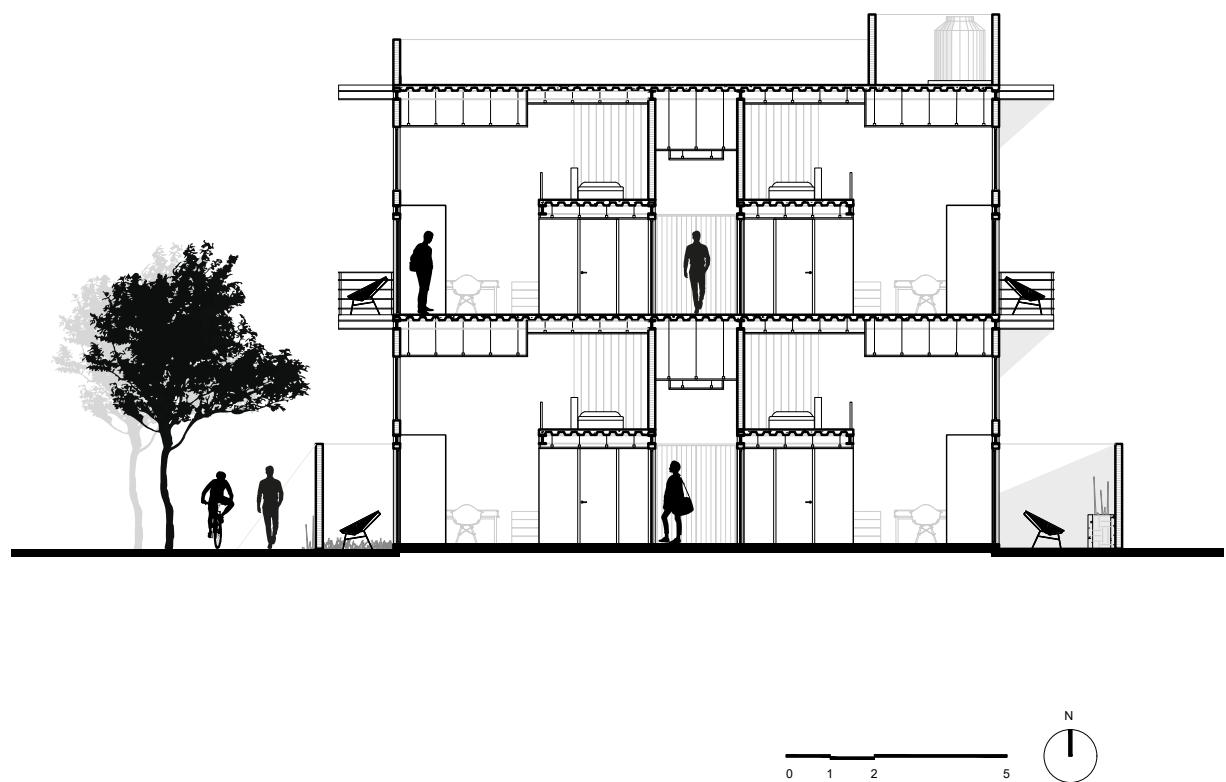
Corte Esquemático de Edificio. Fuente: Elaboración propia.
